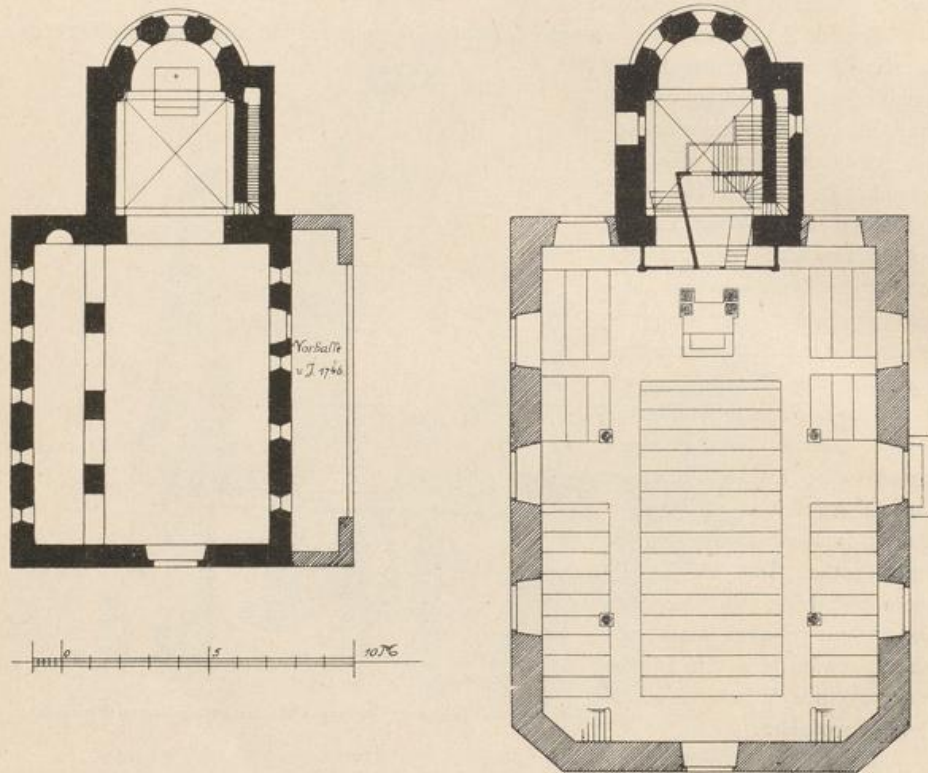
Volberg. Grundrisse der evangelischen Pfarrkirche vor und nach dem Neubau des Langhauses im J. 1788.
